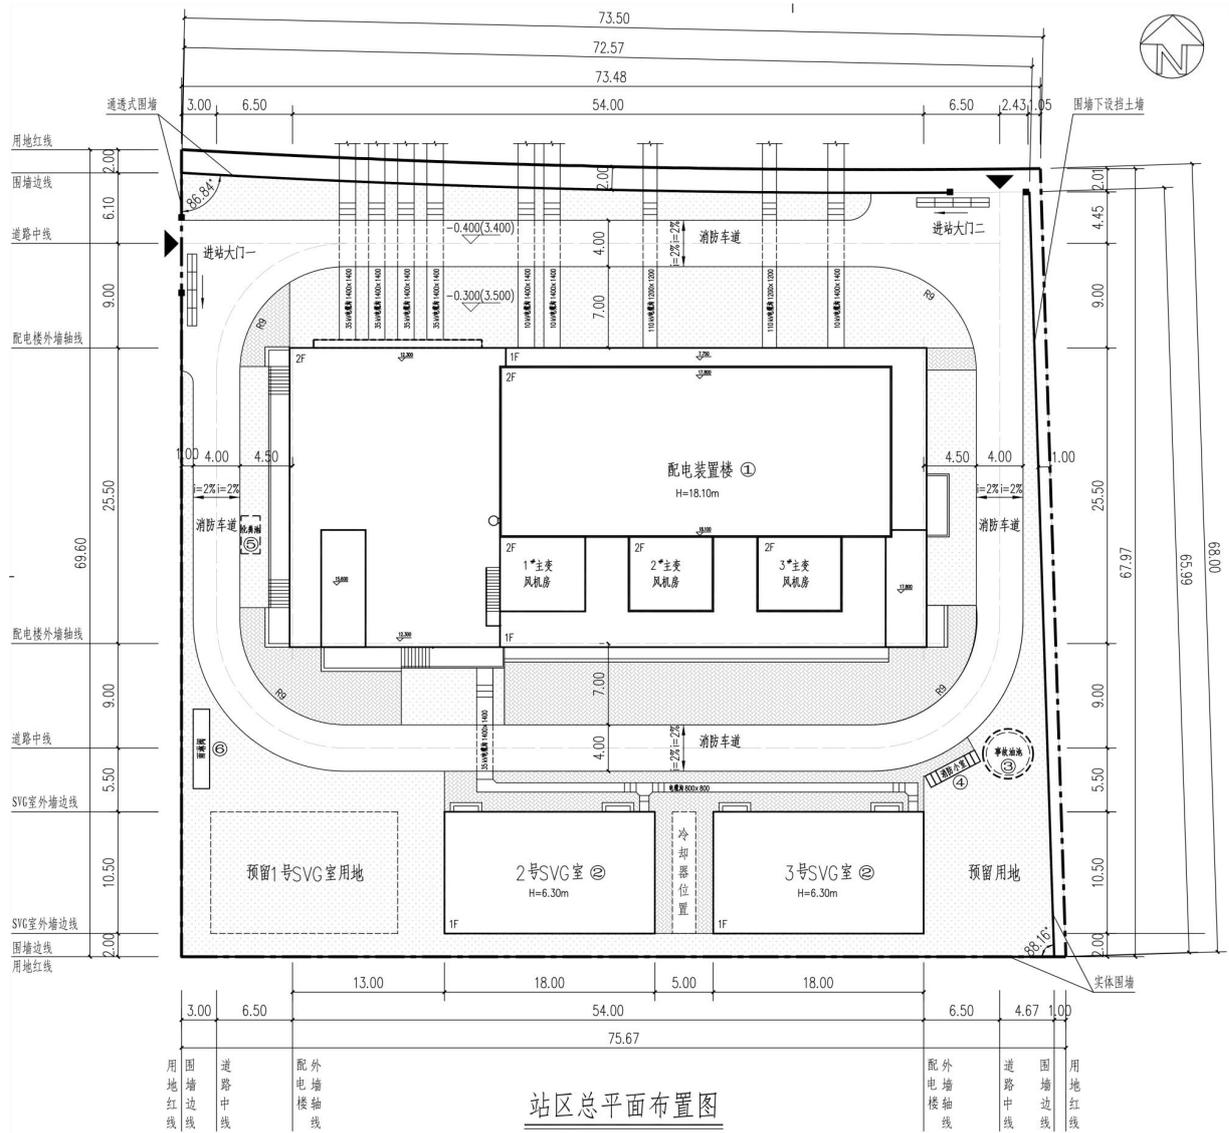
110kV 试验基地变电站总平面布置示意图
